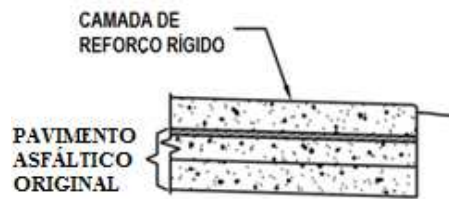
Camada de reforço rígido sobre o pavimento asfáltico (Adaptado - FAA, 2009a).
